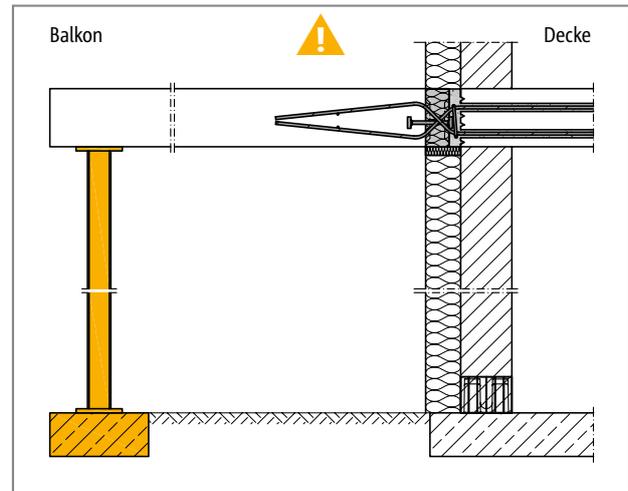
Schöck Isokorb® RT Typ QP-VV: Stützung durchgängig erforderlich
